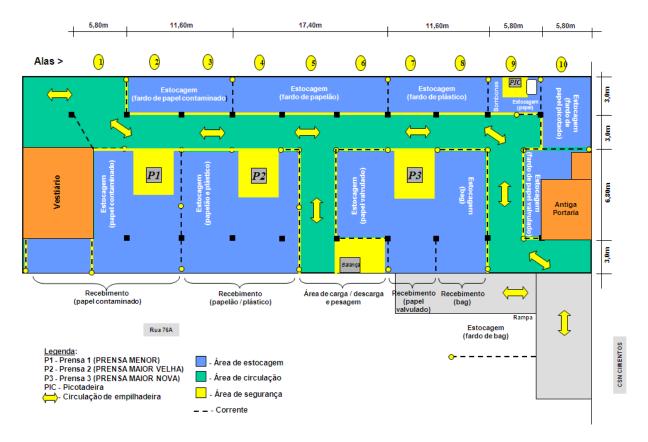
Croqui (planta baixa) do Entreposto de Recicláveis.
